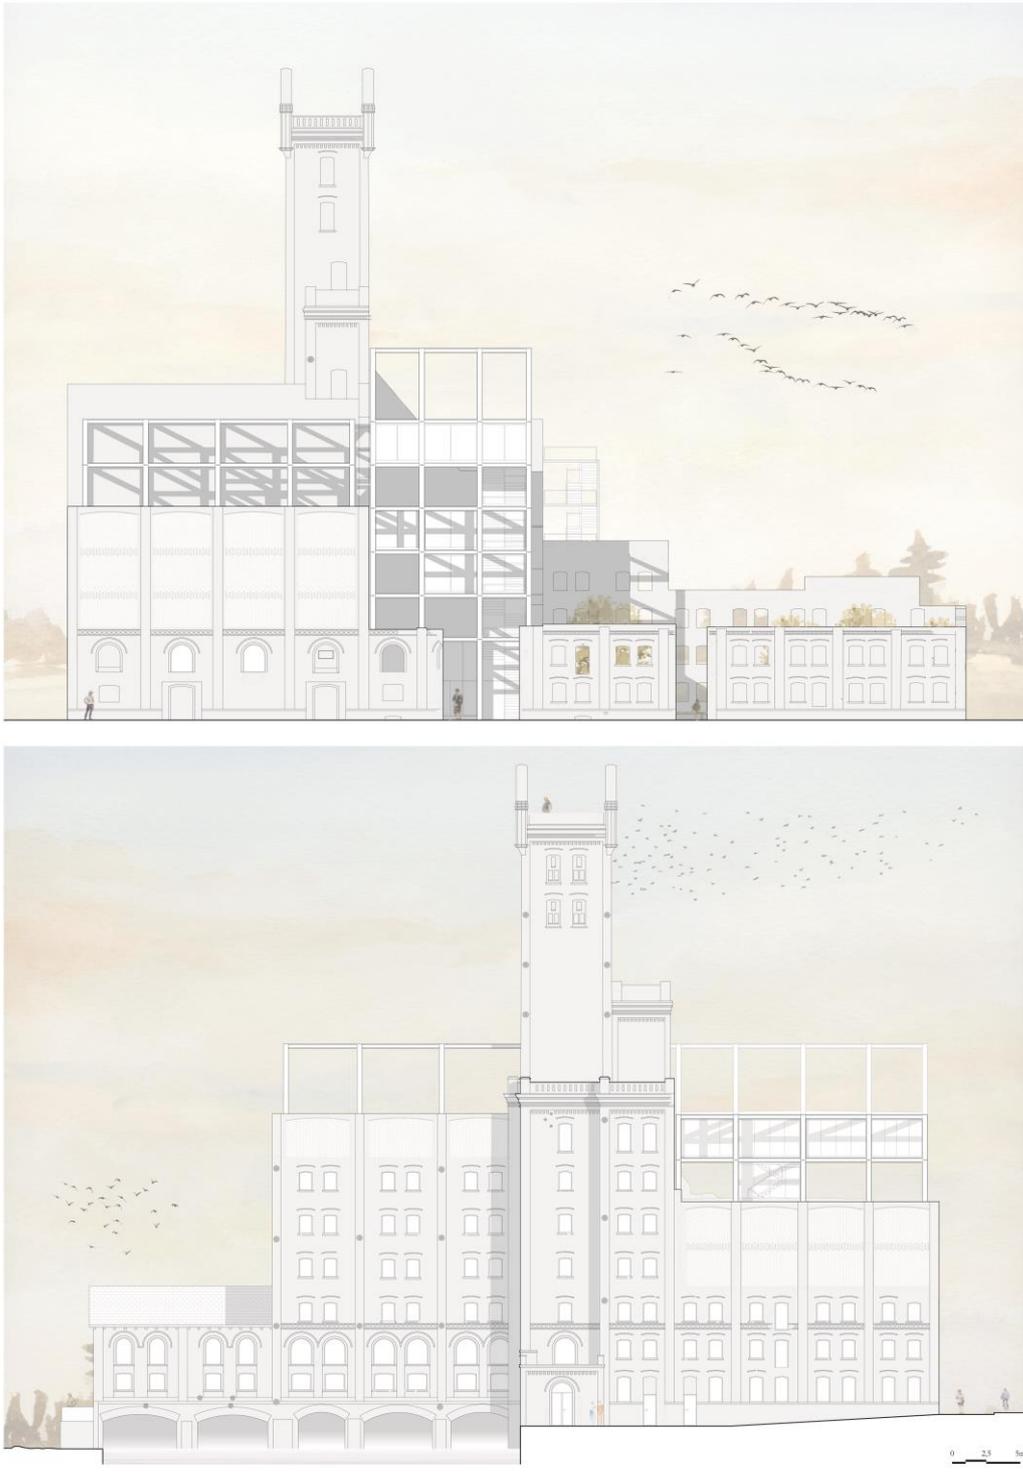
Prospetto Sud-Est e prospetto Sud-Ovest.
